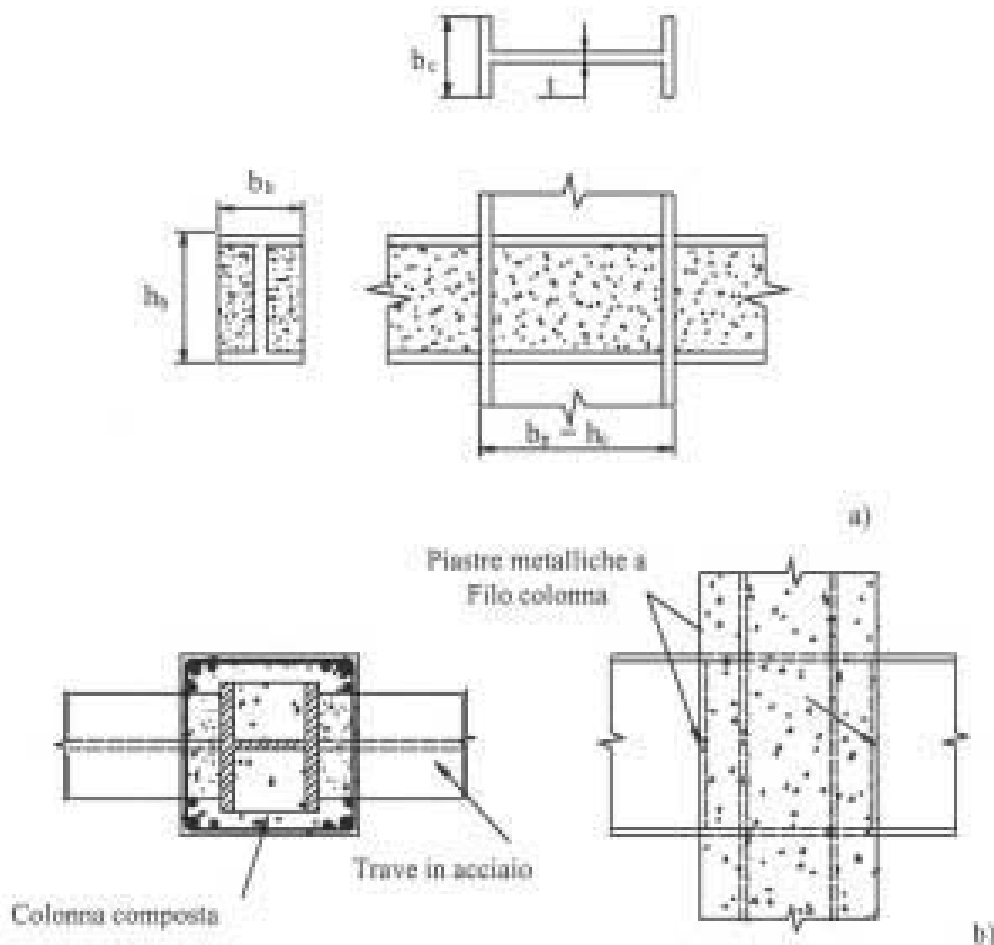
Collegamenti trave-colonna in telai con elementi rivestiti in calcestruzzo
